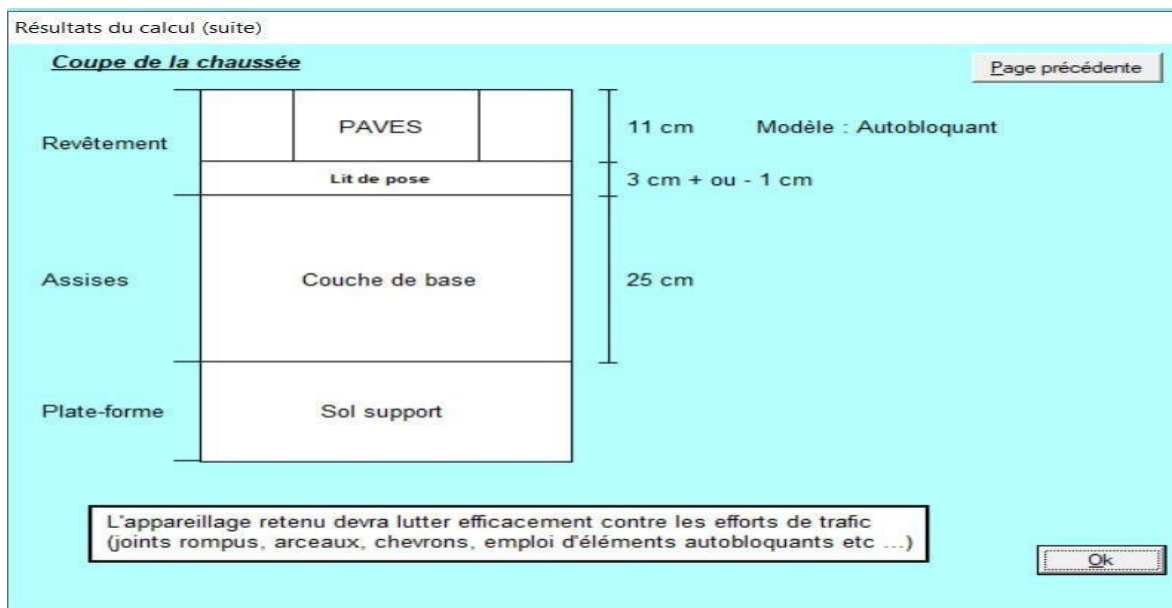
Coupe présentant la structure de la chaussée à l'issue du dimensionnement
